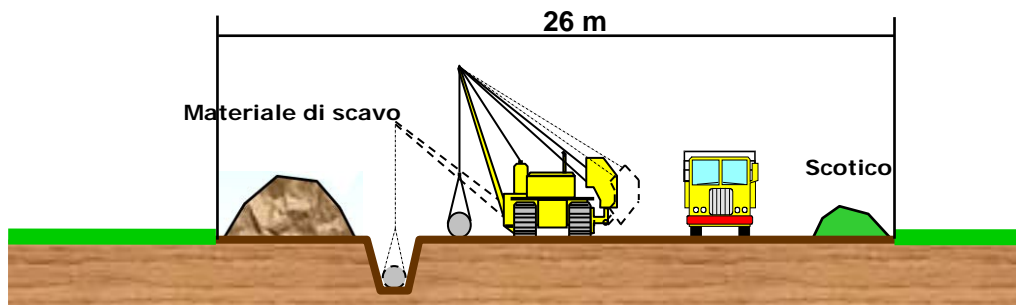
Pista di Lavoro a larghezza ridotta
